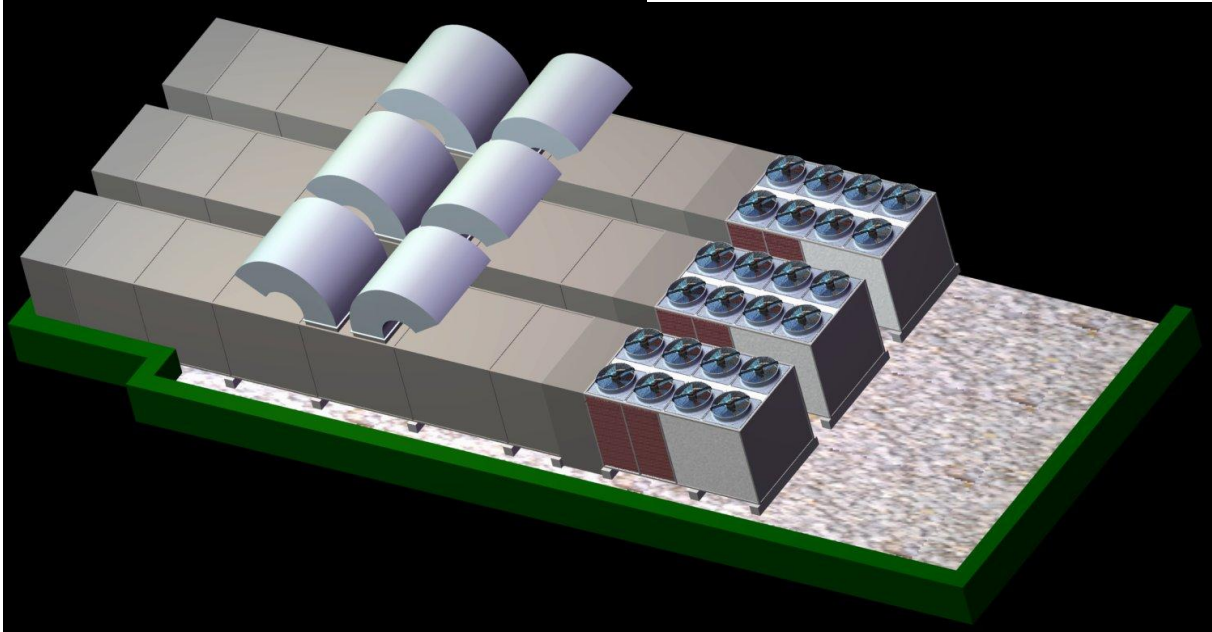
DFCU'S in Dachaufstellung mit 3 X 250 kW Kühlleistung
